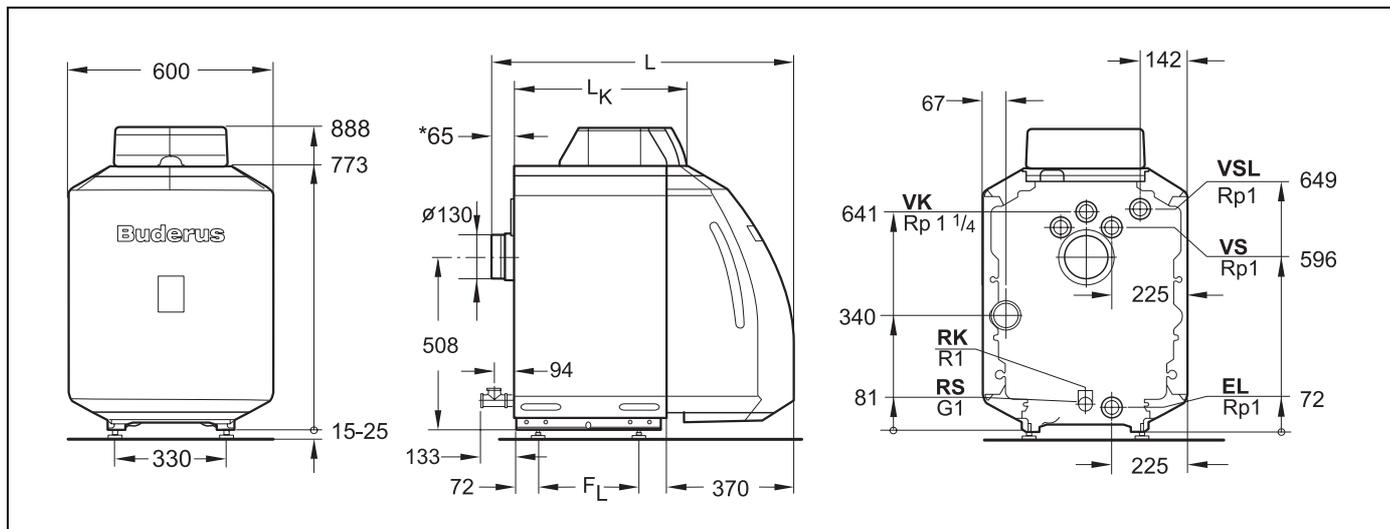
Anschlüsse und Abmessungen (Maße in mm)
